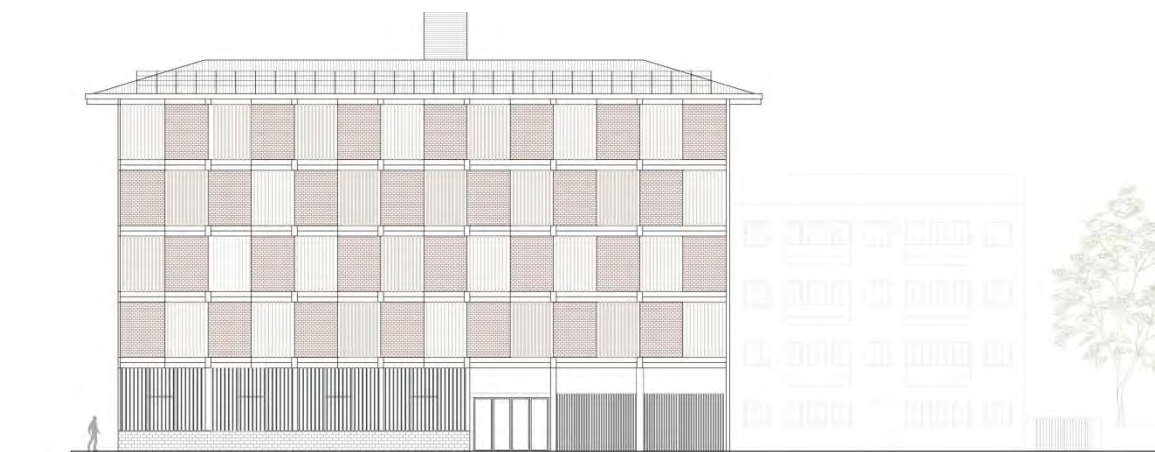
Prospetto est su via Fra' Giovanni Eremitano con ricostruzione del prospetto dell'edificio contiguo
